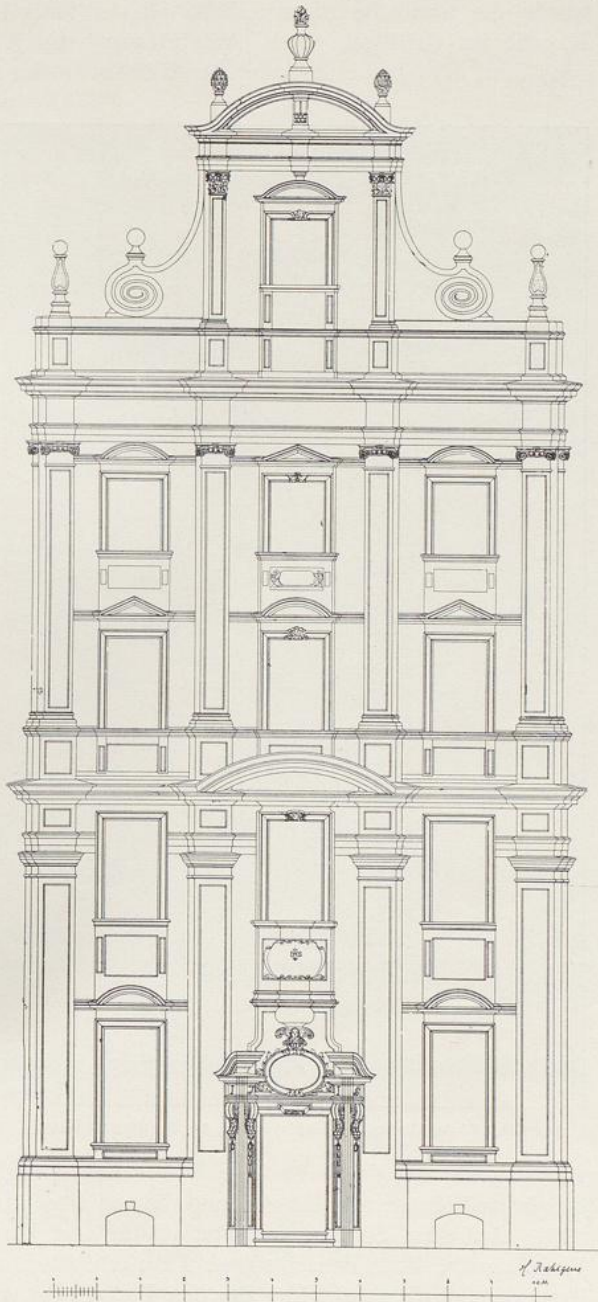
Ehem. Jesuitenkolleg. Fassade a. d. Marzellenstr.
